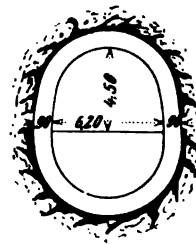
Ausbau einer Strecke in Beton auf Zeche Schmalgraf.
